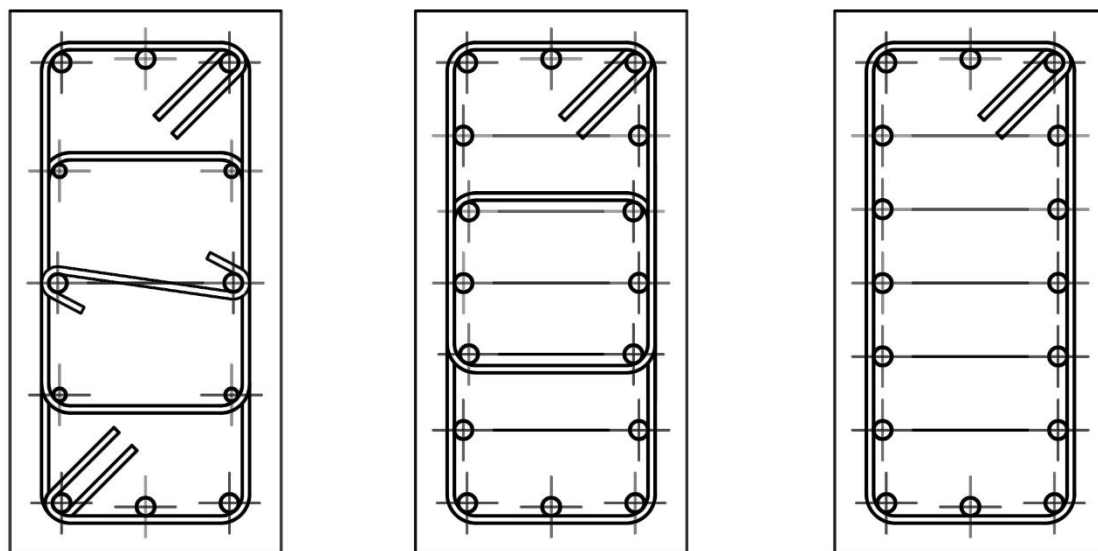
da sinistra verso destra: sezione pilastro 30x60 con staffe a 5 bracci; staffe a 4 bracci; staffe a 2 bracci.
